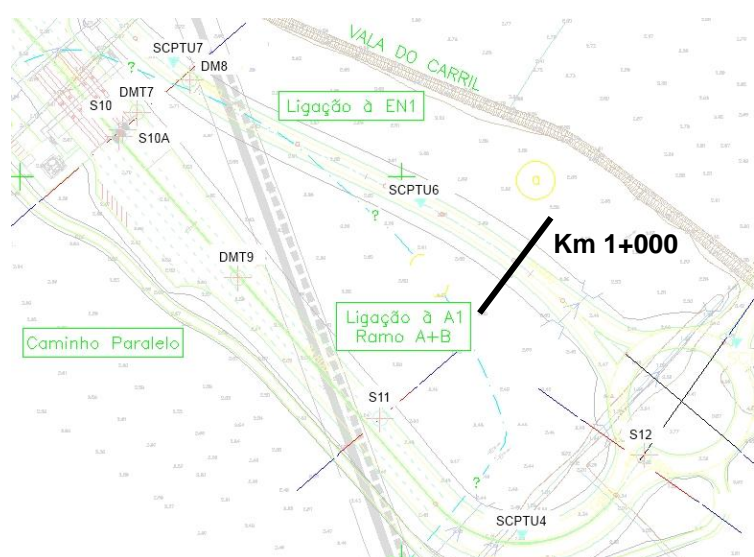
Extrato do plano de prospeção (CENORGE, 2009)
